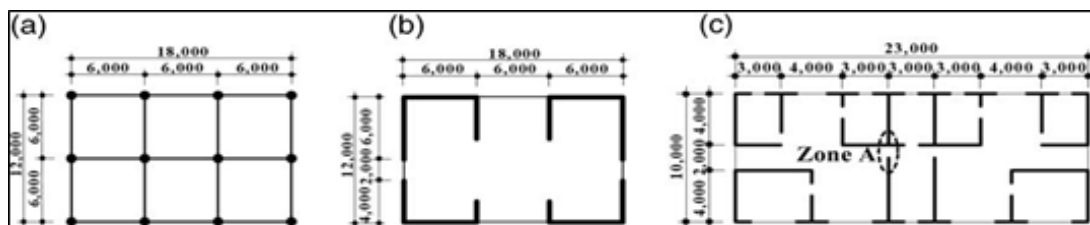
Ejemplo estructuras con losas refinadas. (A) Tipo de plano A, (b) Tipo de plano B, (c) Tipo del plano C.
